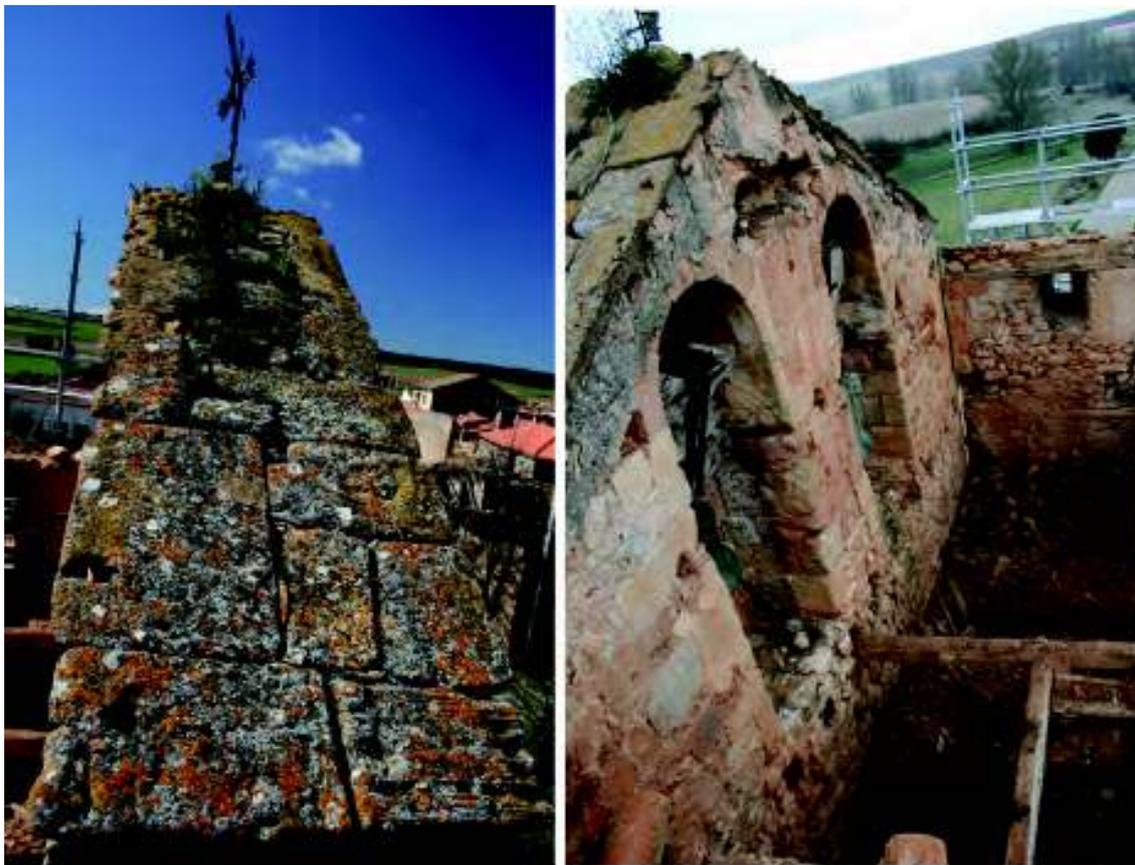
Estado en el que se encontraba la cubrición de la espadaña y el campanario, una vez retirados los elementos que quedaban de su estructura de cubierta (2009). Fot.: SR.
